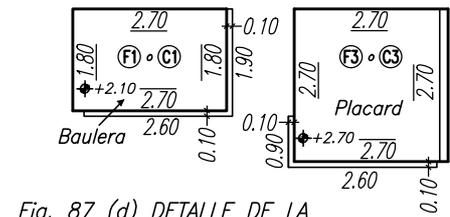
(d) DETALLE DE LA BAULERA Y DEL PLACARD
